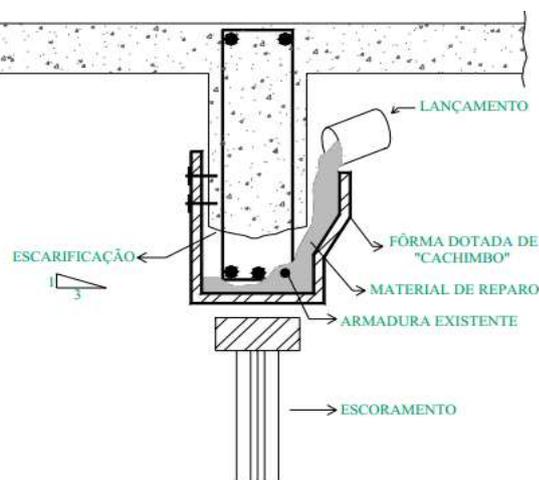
Esquema da aplicação de concreto em reforço de vigas (HELENE, 1992)
